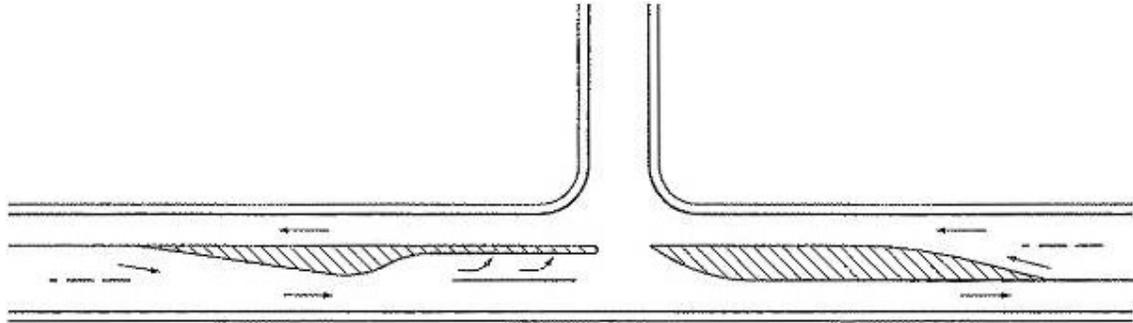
Esquema de intersección de tres ramales en una calzada 2+1
